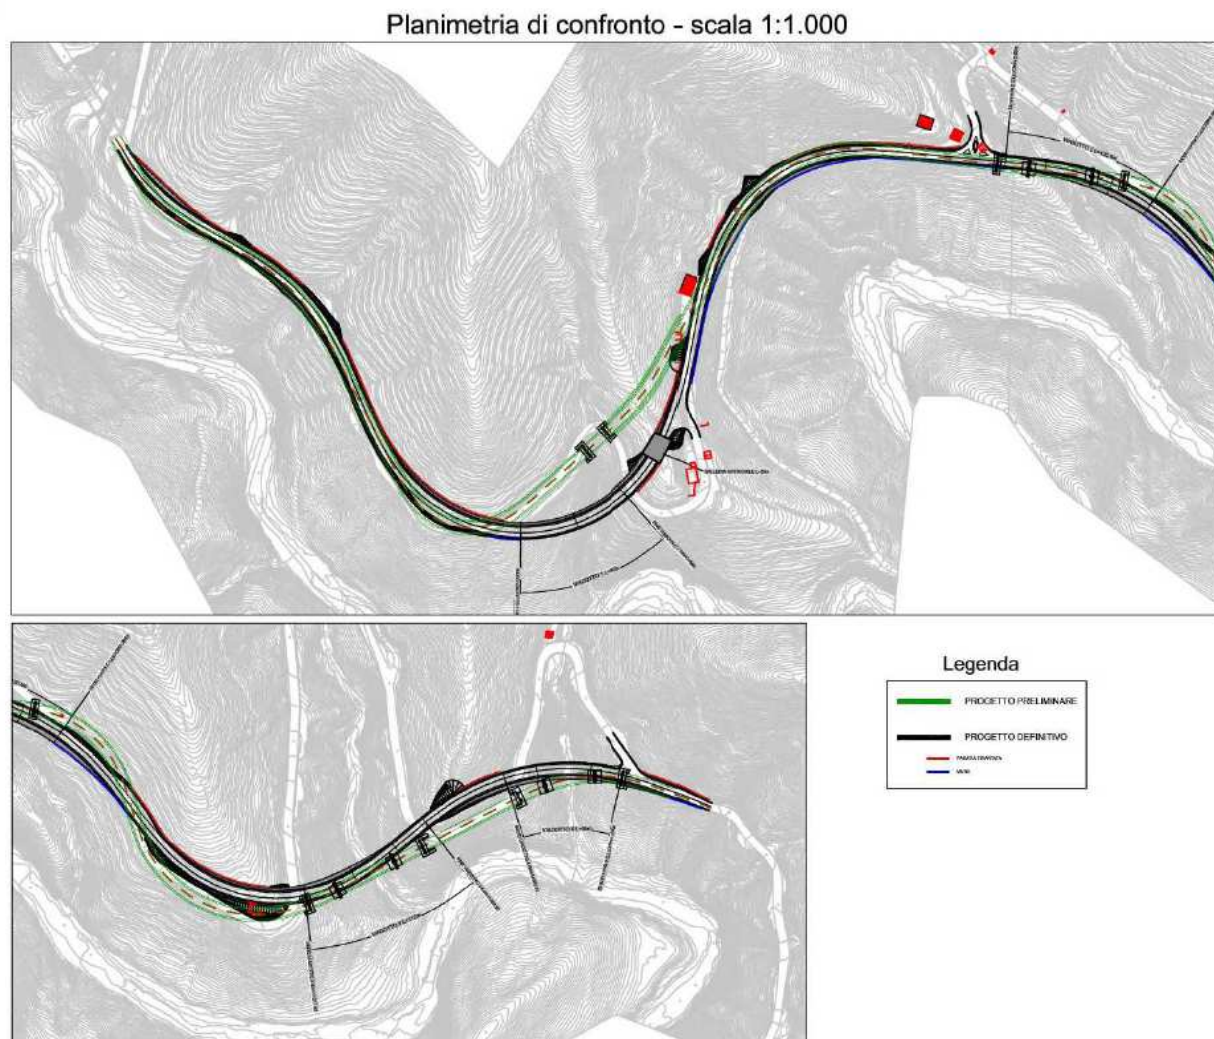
Confronto tra il progetto preliminare (in verde) ed il progetto definitivo
